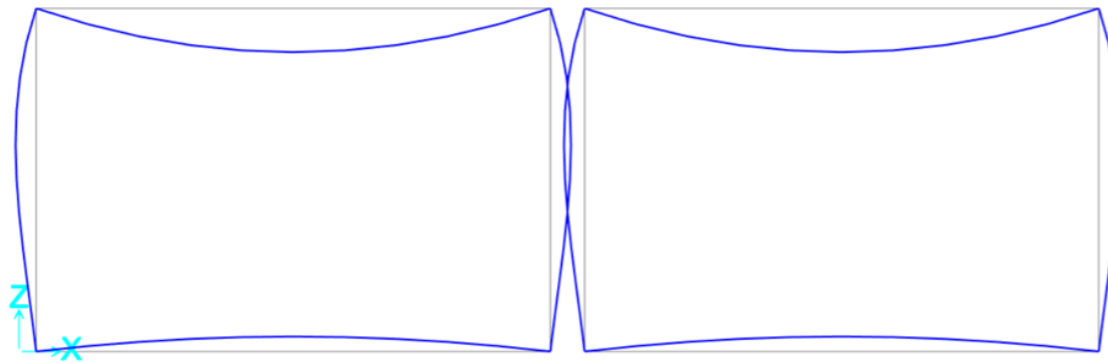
Deformada en sección vacía para ELS5. Fuente: SAP2000
